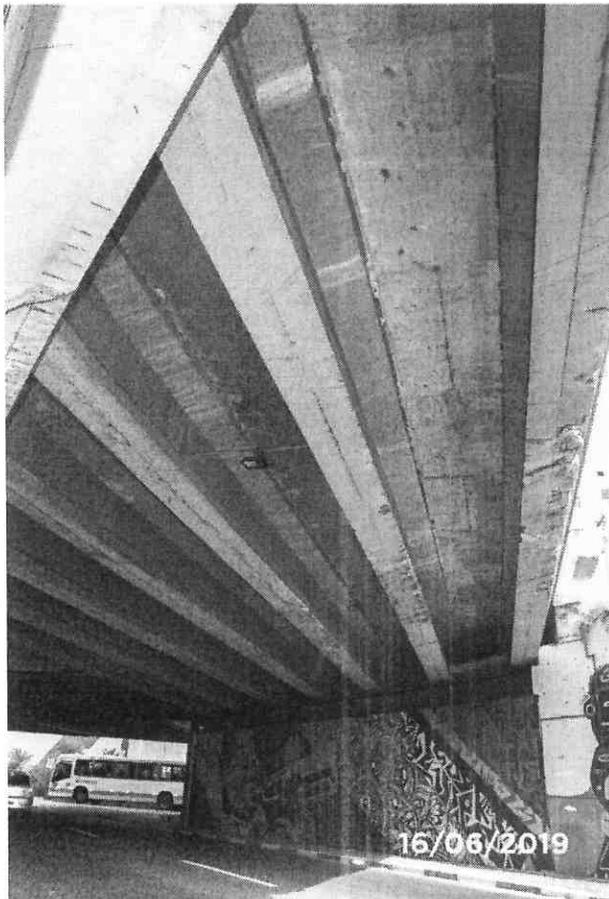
Vista da face inferior do tabuleiro, sentido rodovia. Vigas com deslocamento de concreto, infiltrações, armaduras expostas.
